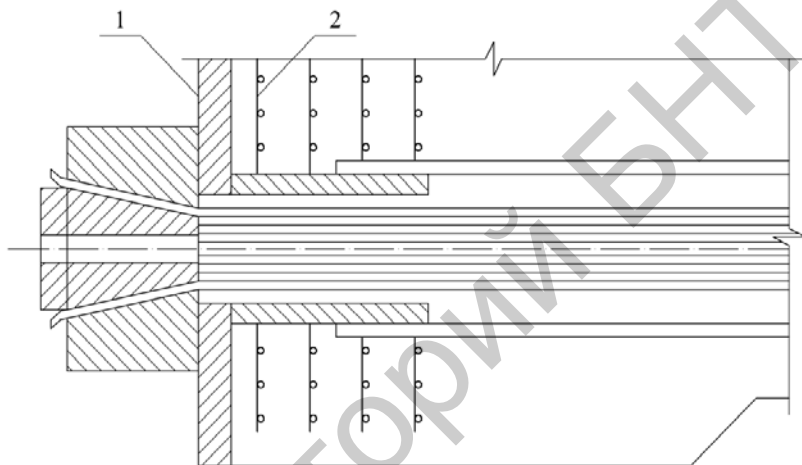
Усиление торца предварительно напряжённого элемента под анкерами на опорах (натяжение арматуры на бетон):
